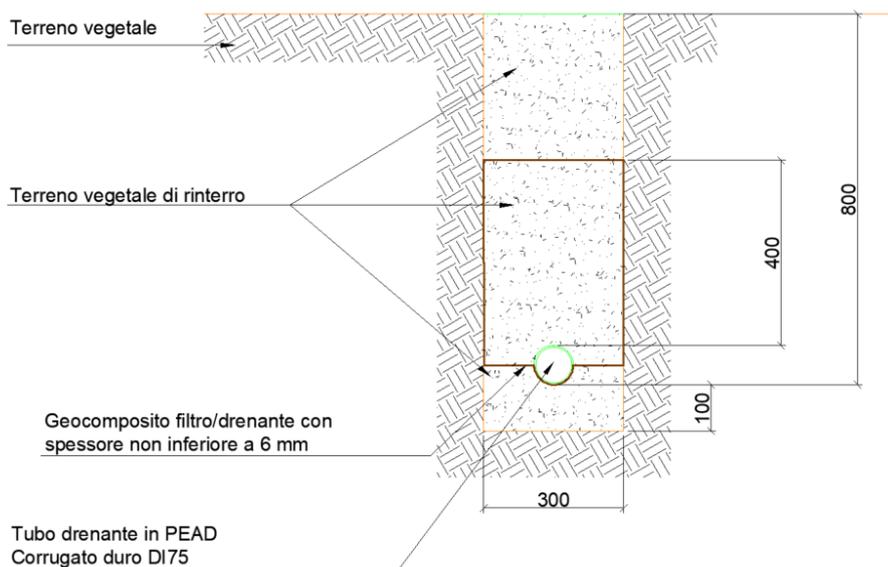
Sezione trincea drenante con tubazione DI 75 e riempimento dello scavo con terreno vegetale
